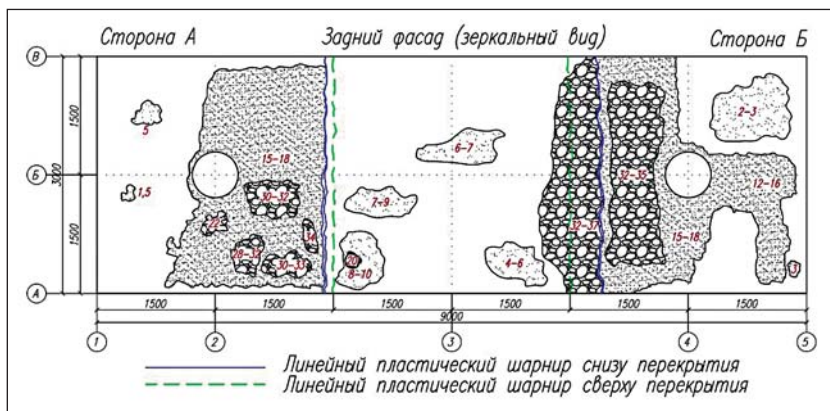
Распределение повреждений железобетонного монолитного перекрытия снизу
